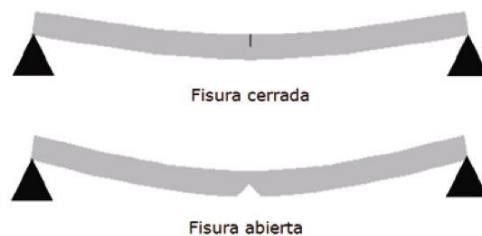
Esquema de las situaciones de fisura completamente cerrada y completamente abierta [1]
